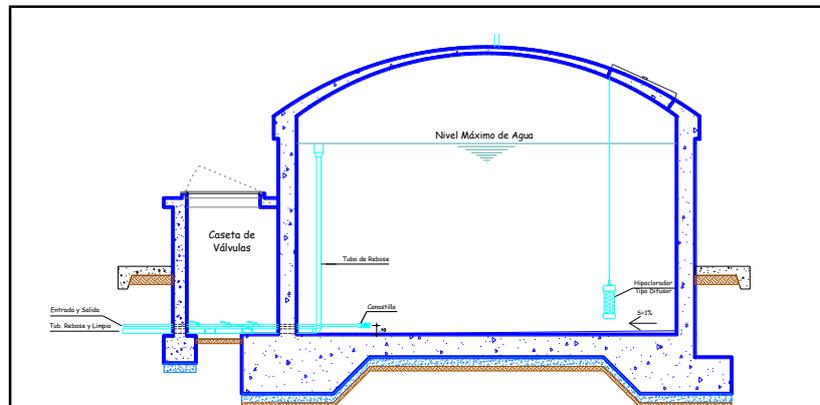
Figura 21: Vista en corte del reservorio apoyado circular proyectada.
